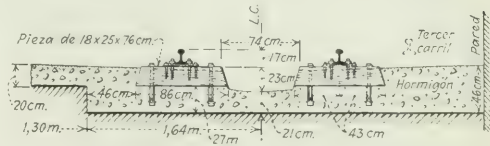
PISO TÍPICO DE HORMIGÓN PARA TÚNELES Y ESTACIONES
